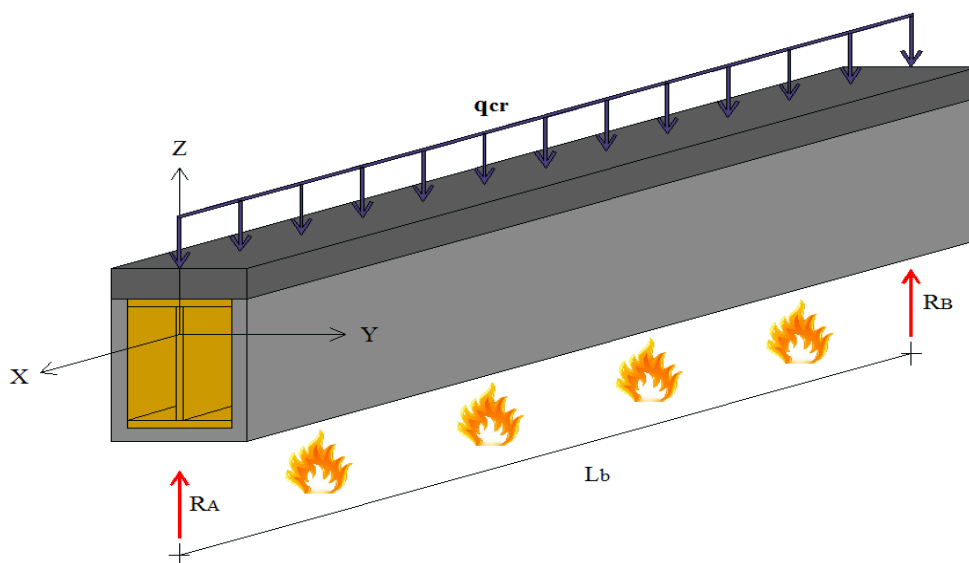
Viga I em perfil metálico, com carga uniformemente distribuída, submetida à situação de incêndio – Perfil com revestimento.
